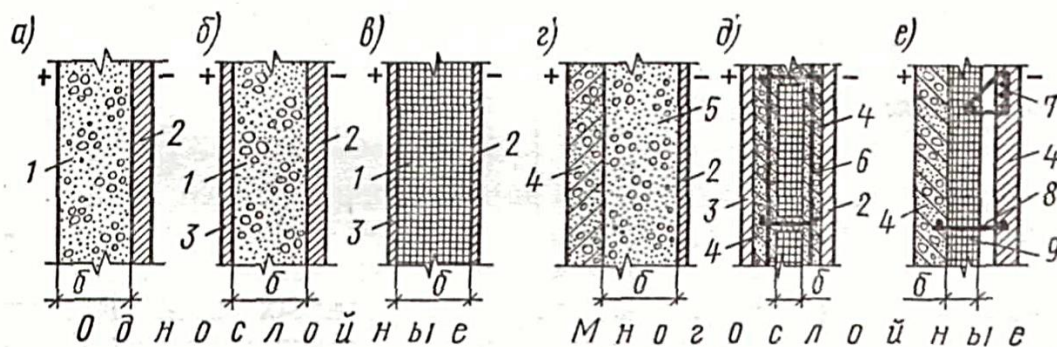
Составные элементы поперечных сечений наружных железобетонных стеновых панелей:
